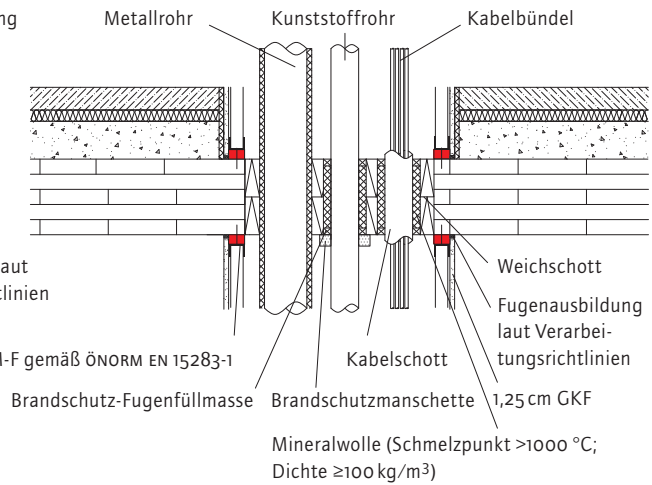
Anschlussdetail einer Holzdecke bei Schachttyp B horizontal abgeschotteter Schacht
